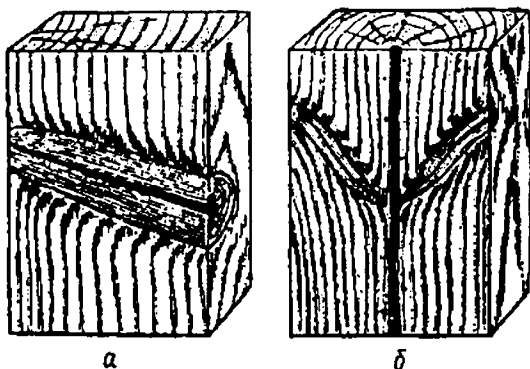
Сучки: а - шивной; б - разветвленный
